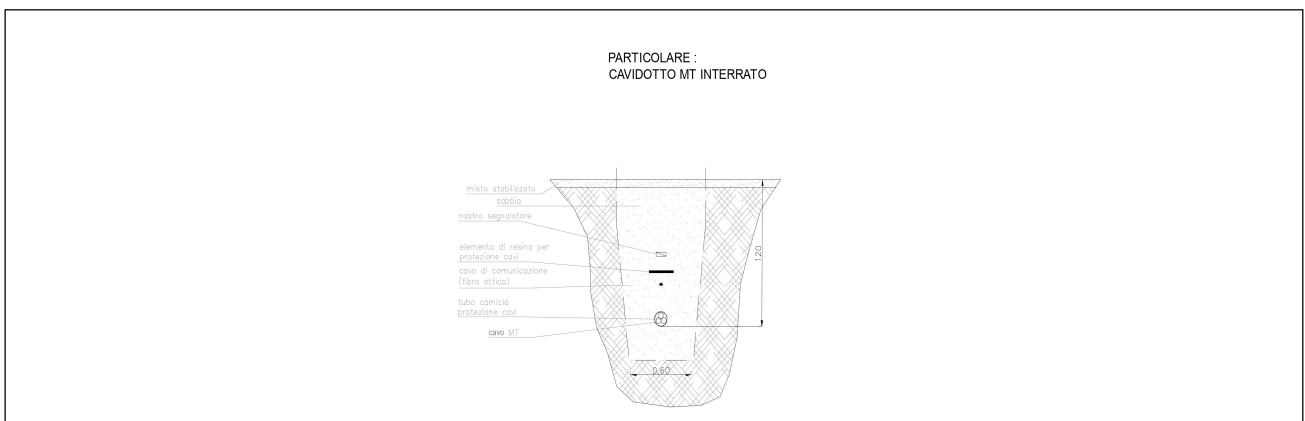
Particolare costruttivo posa cavidotto MT 30 kV singola terna
